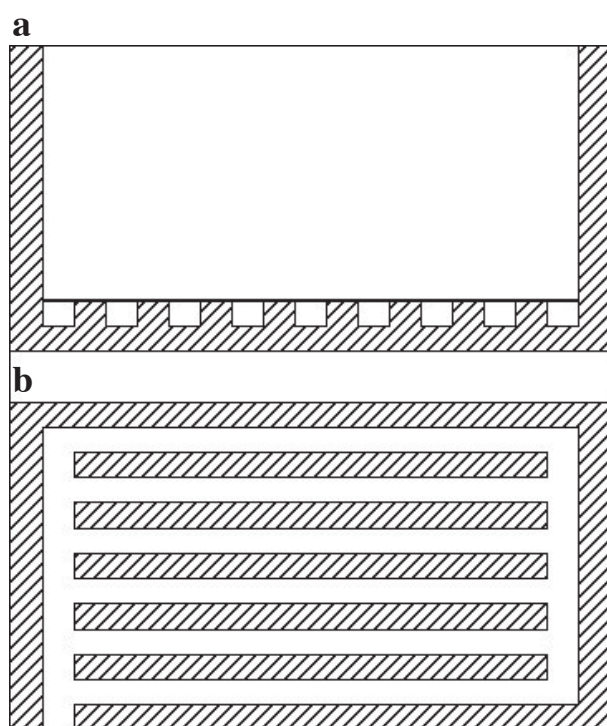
Esquema de platea para apoyo de piso de paneles pre formados. a) Corte; b) Planta
